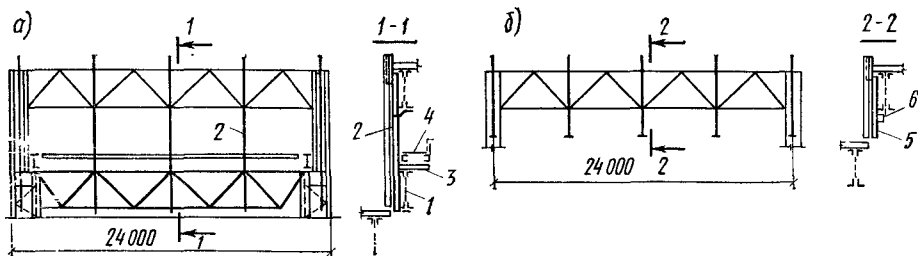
Пример решения факхверка внутренней поперечной стены из кирпича
